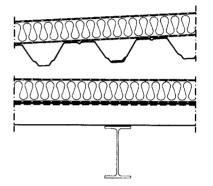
Einschaliges oberseitig wärmegedämmtes Trapezprofildach
